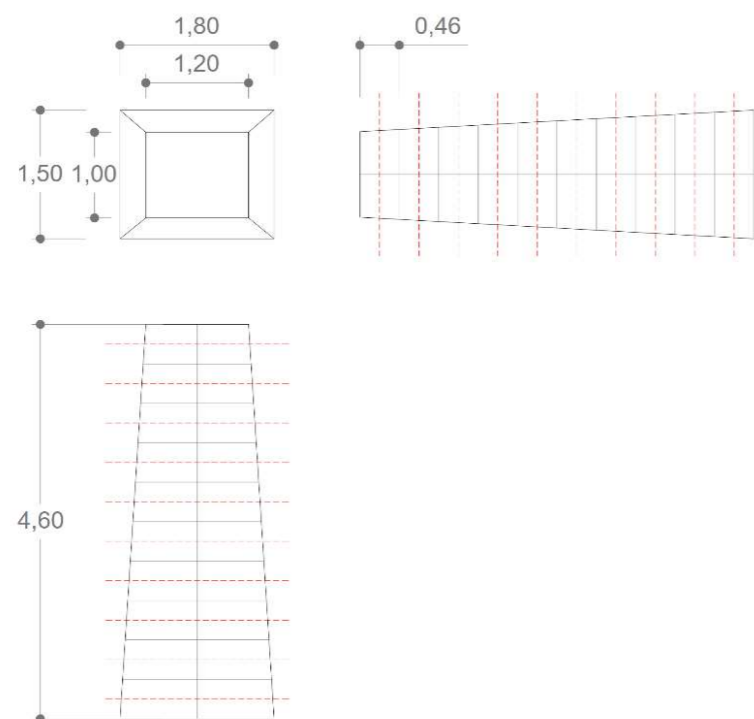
División de las pilas en diez barras y secciones introducidas en cada barra (fuente: elaboración propia)
